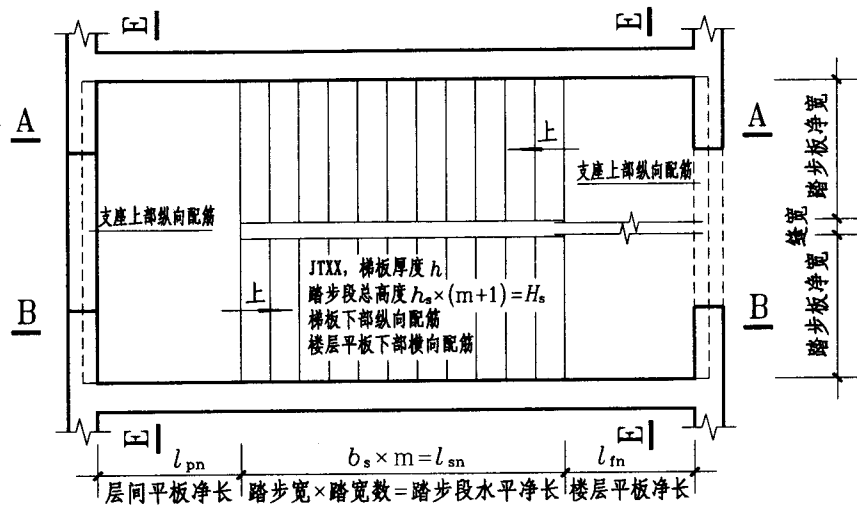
注写方式 标高XXX—标高XXX楼梯平面图
